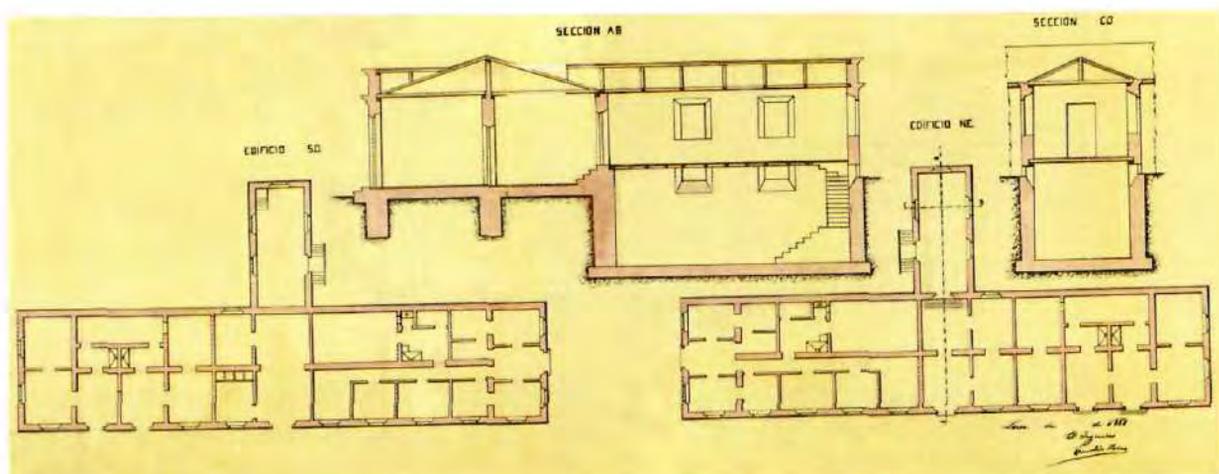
Planta y sección de los pabellones del cementerio. Ingeniero Riera. 1888
